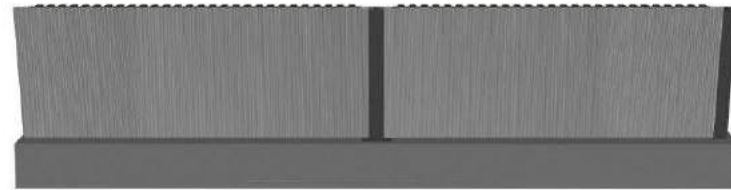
Exemples de murs anti-bruit en béton balayé
